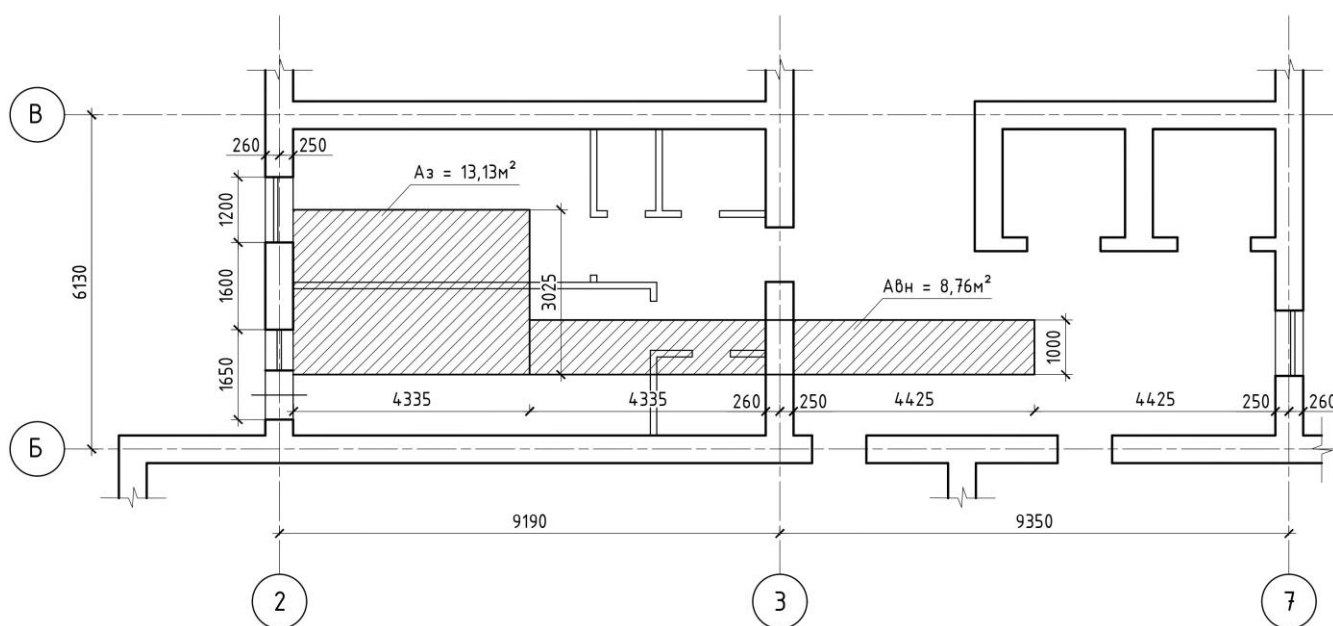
Вантажні площі для розрахункових фундаментів
